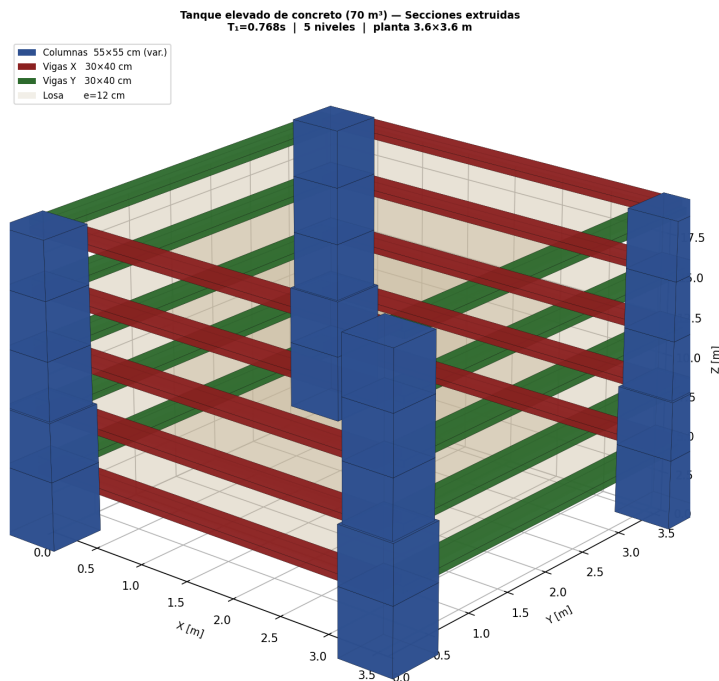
Modelo 3D extruido — secciones reales de vigas y columnas.
